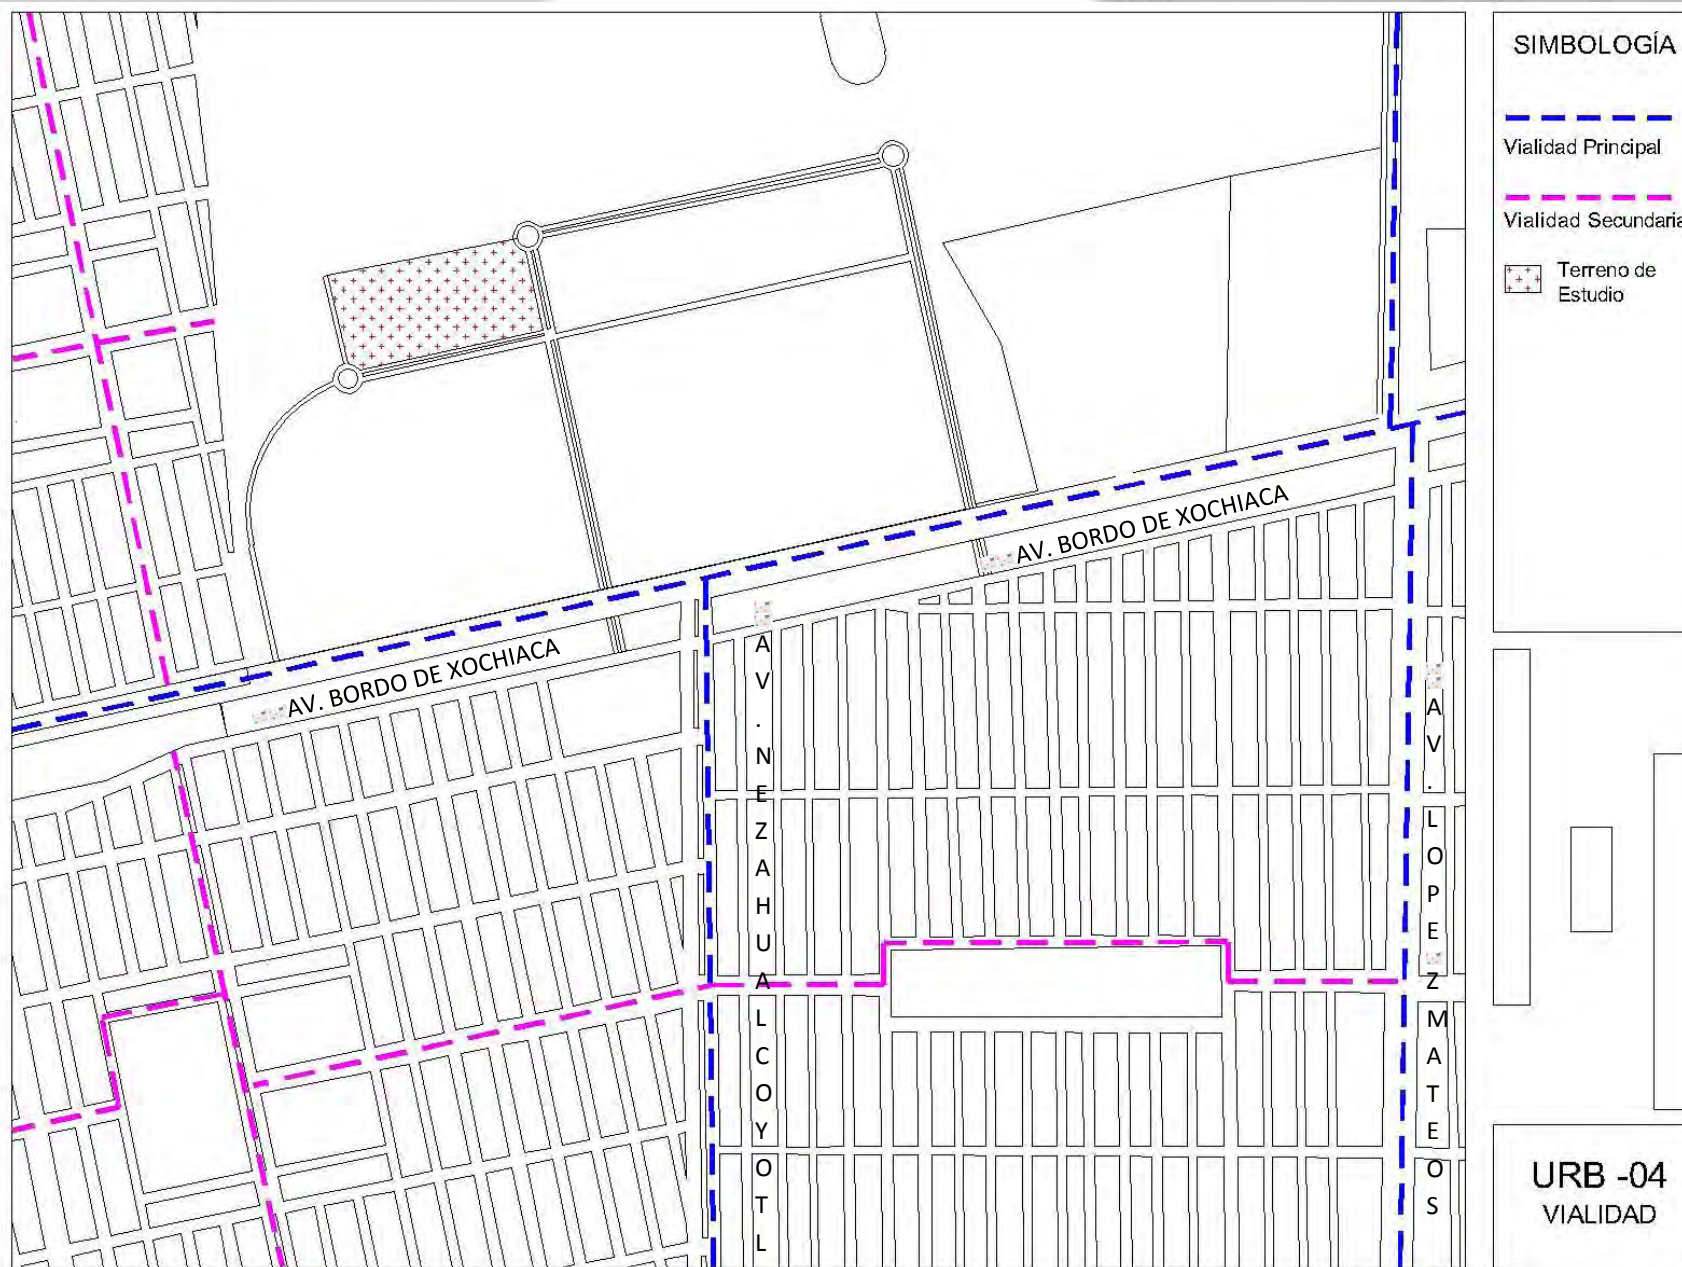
Plano Vialidad – Dibujo de Autoría Propia
